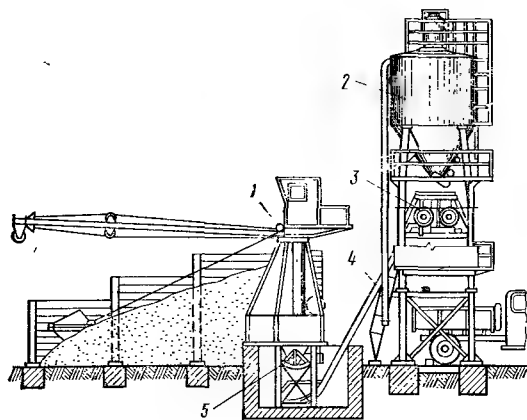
Схема инвентарной бетоносмесительной установки:
